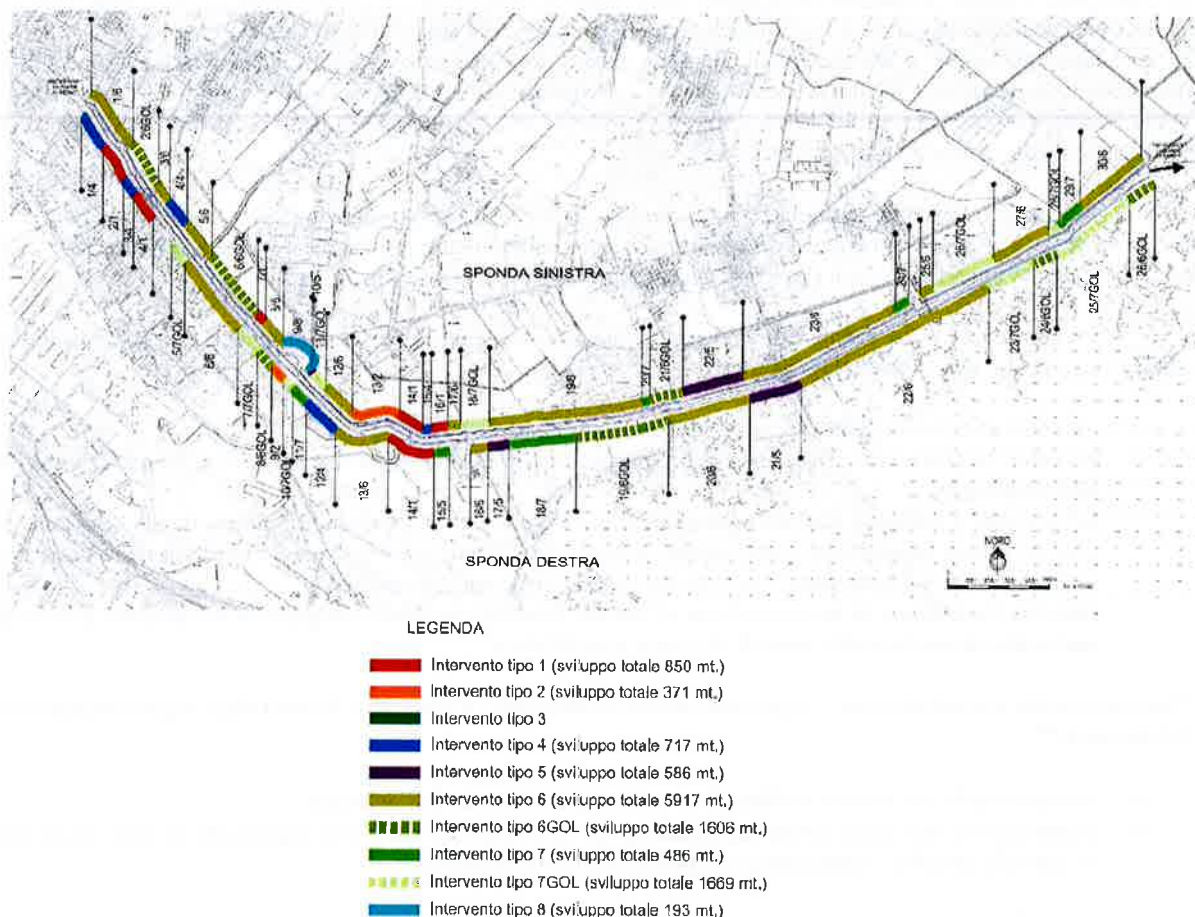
Planimetria generale degli interventi del progetto complessivo.
